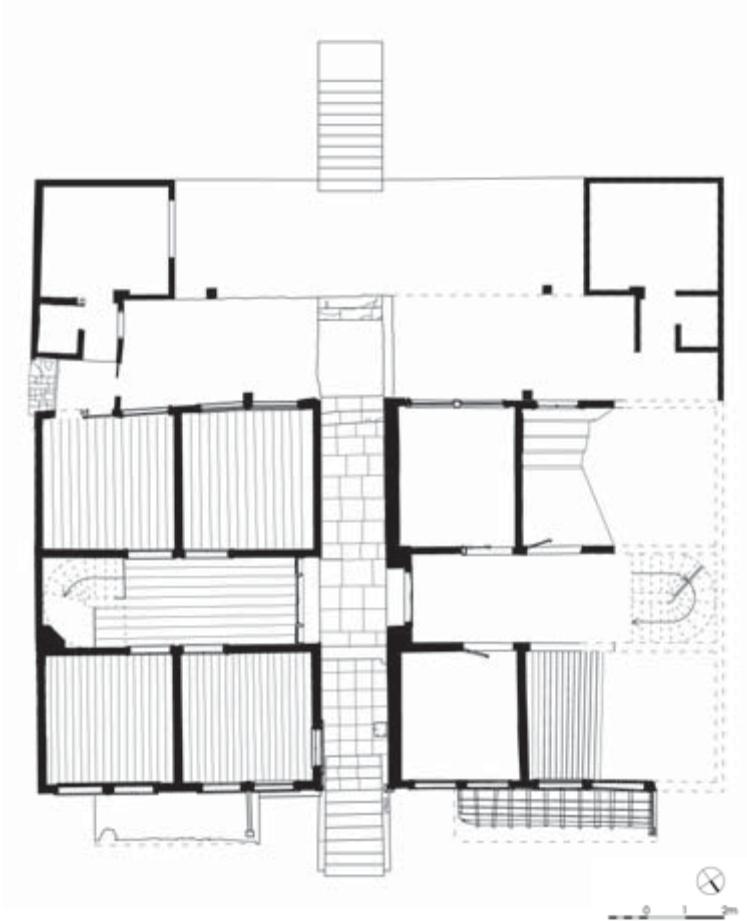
Erdgeschossgrundriss des Doppelhauses Sulyoti İkiz Evleri auf Büyük Ada in der Bauaufnahme, M. 1:200
